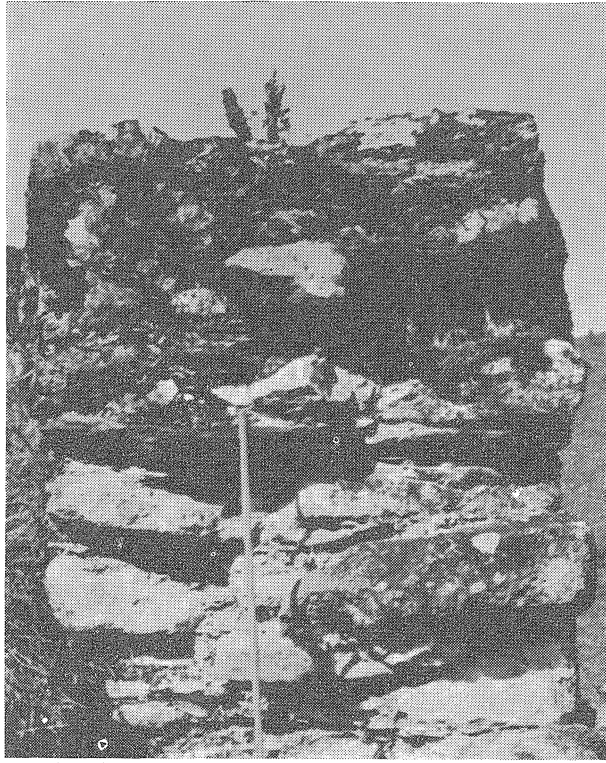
Imagem da muralha envolvente vendo-se nitidamente, a argamassa de ligação.
